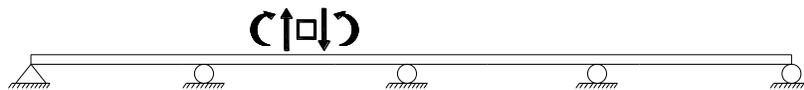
Esfuerzos a los que está sometido un puente tipo viga.
